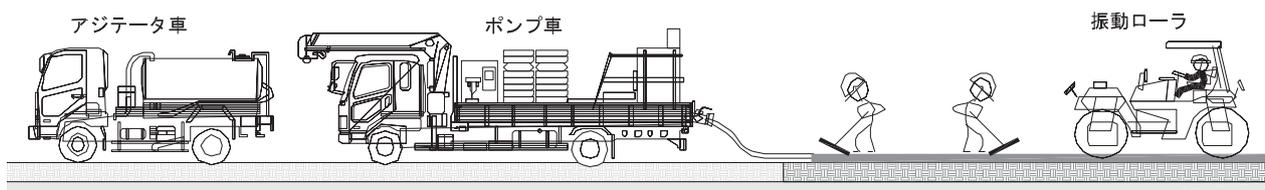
半たわみ性舗装（セメントミルク注入）の施工状況
